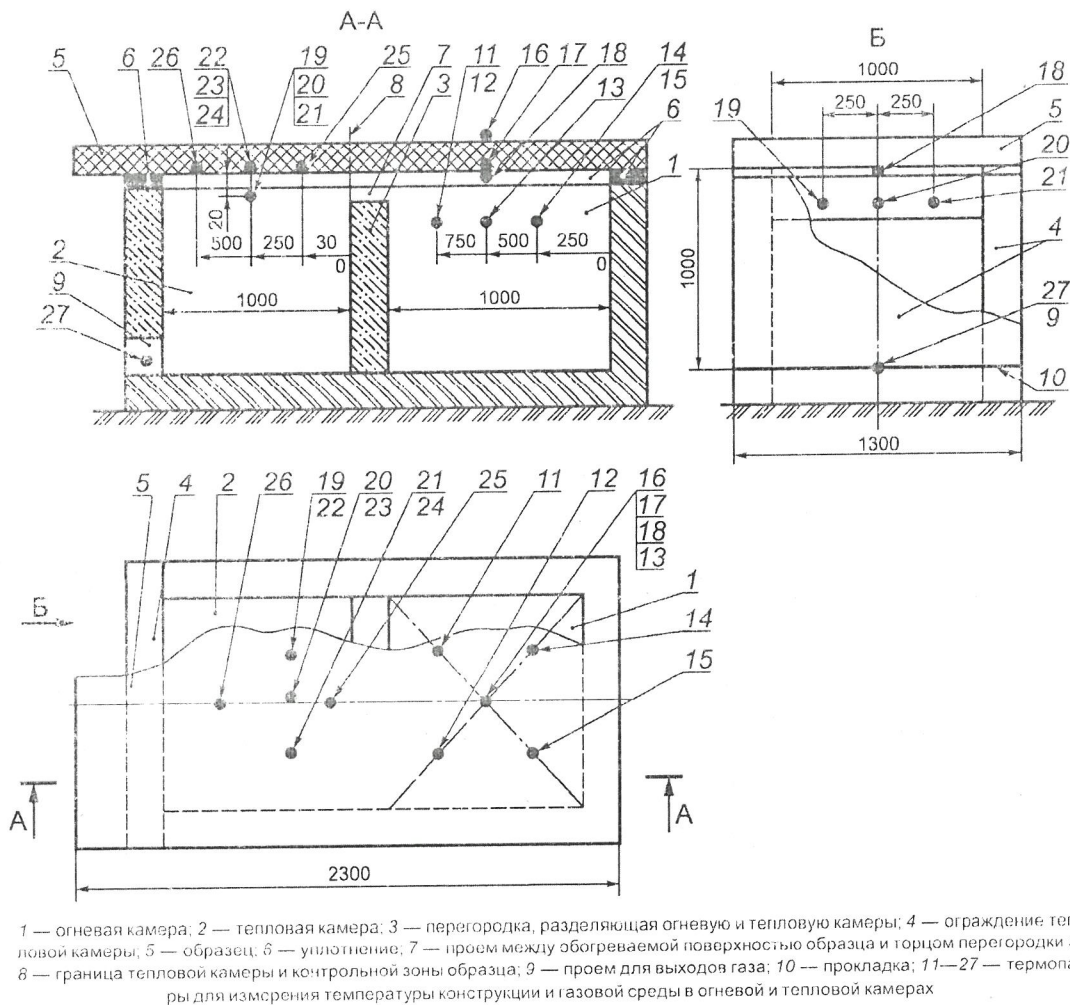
Схема печи для испытаний горизонтальной конструкции и установка на ней образца конструкции.
